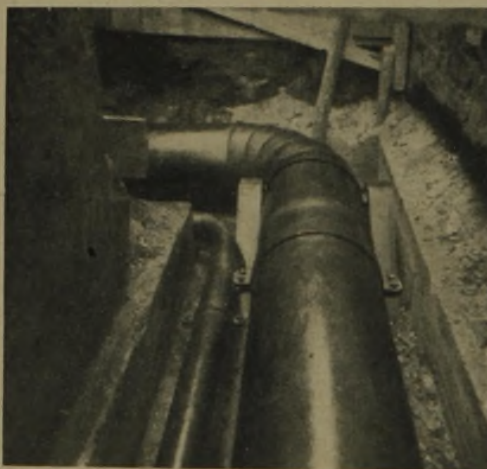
Knie-Ausbildung einer Dampf- und Kondensleitung durch Schweißung.
